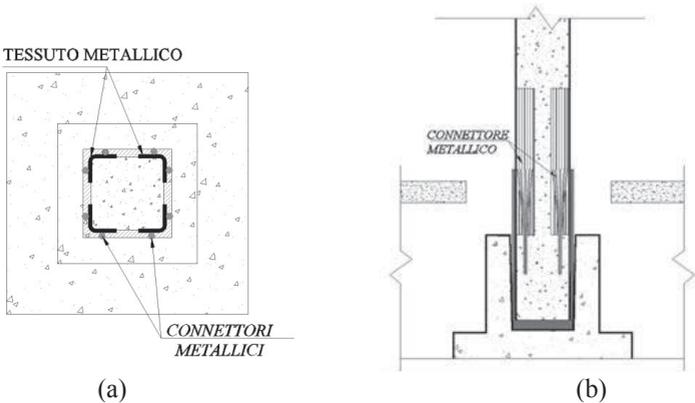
Disposizione dei connettori per l'ancoraggio del tessuto metallico alla fondazione (a) pianta e (b) sezione.
